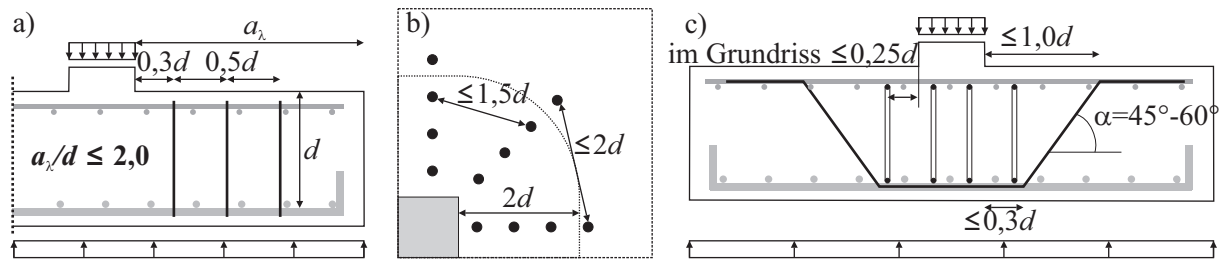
a) Zulässige radiale Bügelabstände für gedrungene Fundamente, b) zulässige tangentielle Bügelabstände im Grundriss sowie c) zulässige Abstände für Schrägstäbe
